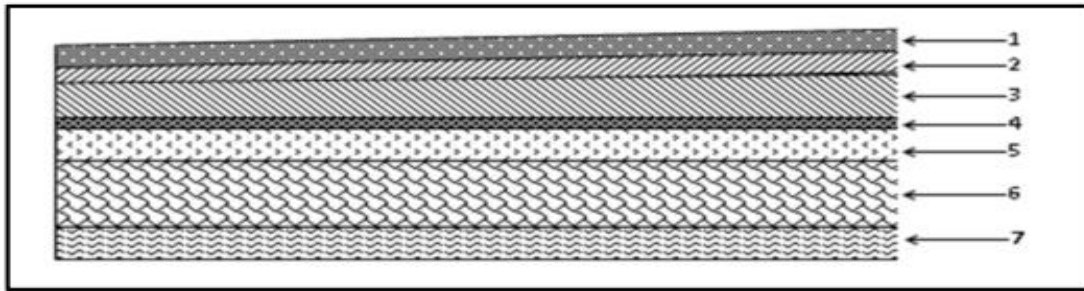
Coupe transversale du plancher terrasse inaccessible
